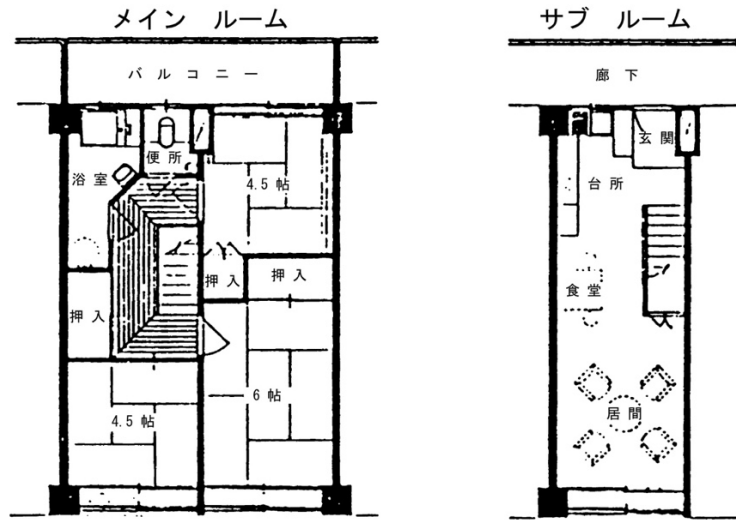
四谷コーポラスのメゾネットタイプの平面図²⁾
